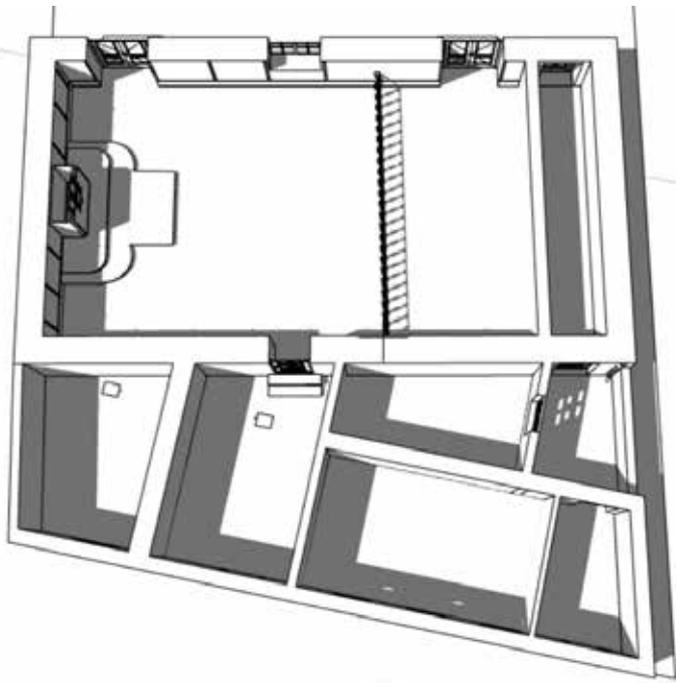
3D Grundriss nach Modellierung, EG
